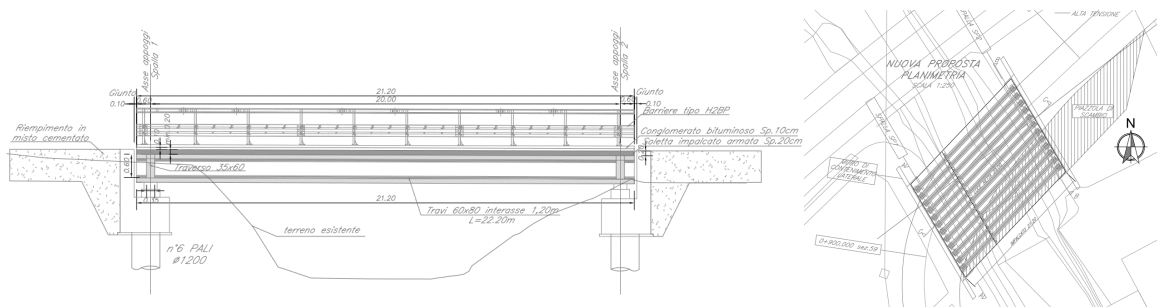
Sezione e posizione planimetria del nuovo ponte sul Rio Funes.
